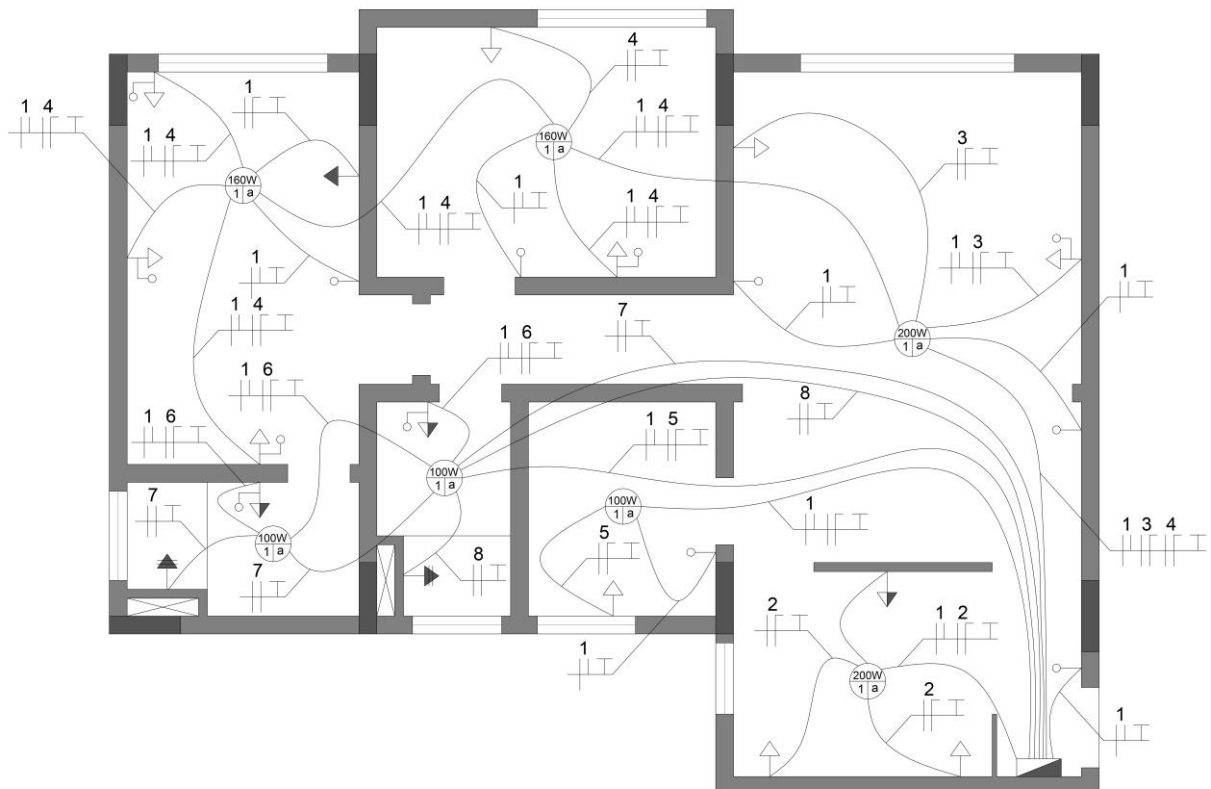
Planta de elétrica do apartamento de 74,19m²
